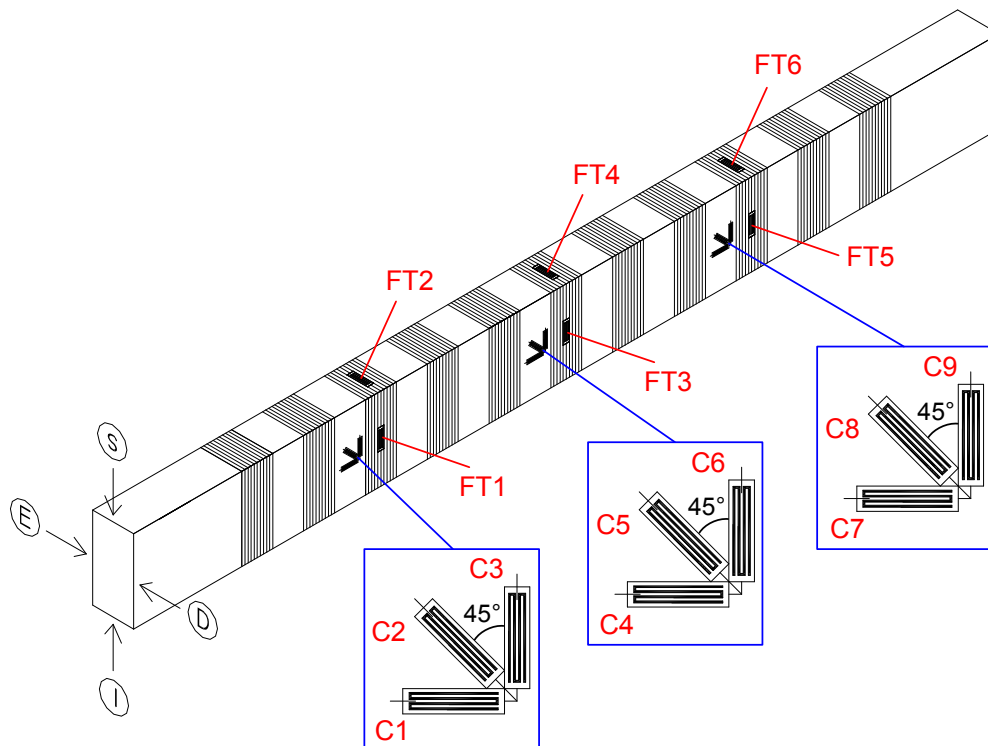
Instrumentação no concreto e no CFC das vigas da série VT.
